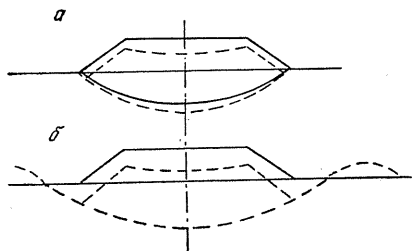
Осадка насыпи: а — сжатие грунта основания; б — выжимание грунта из-под насыпи
